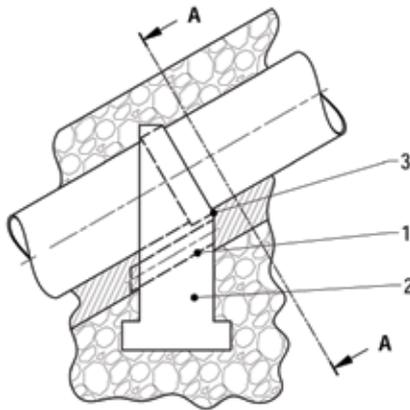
Seitenansicht eines Auflagers für Steilleitungen
